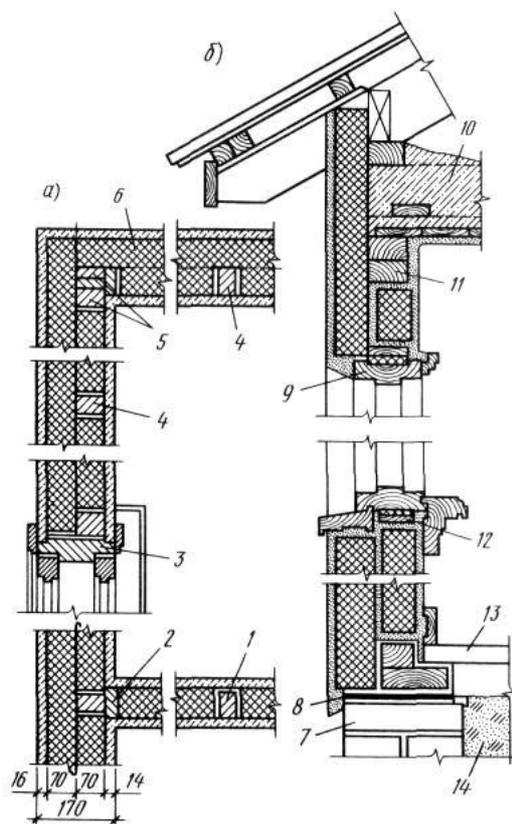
Детали конструкций каркасного дома с утеплением стен фибролитовыми плитами
